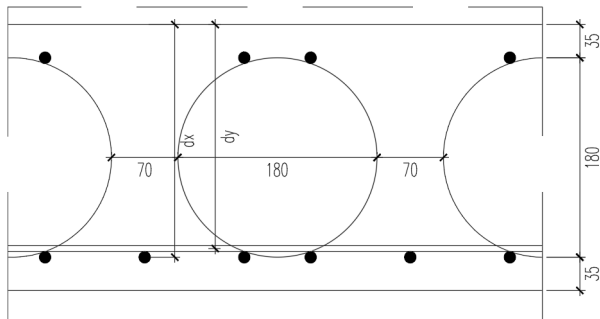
28. Detail BD230 Lajur Kolom Lapangan Arah X
